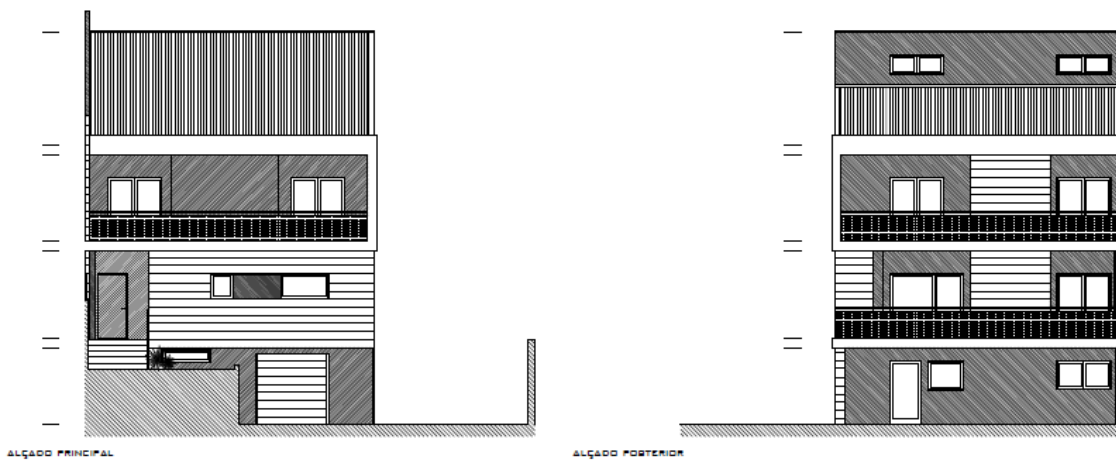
Elevação principal à esquerda e elevação posterior à direita.
